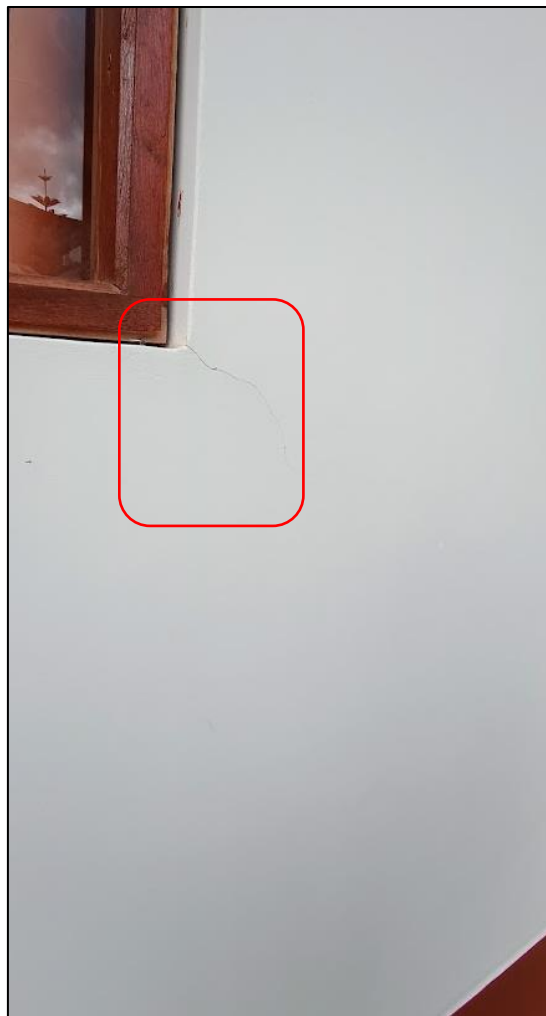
Vista de fisura vertical en muro de fachada oeste.
